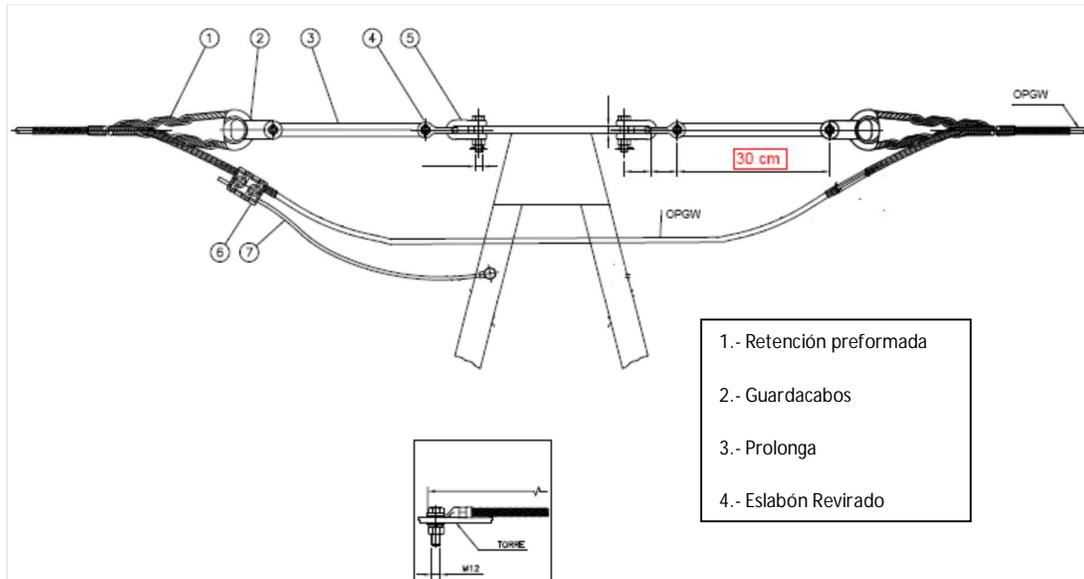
Referencia de conjunto de amarre pasante de OPGW para ser instalado en los 2 extremos de la torre
